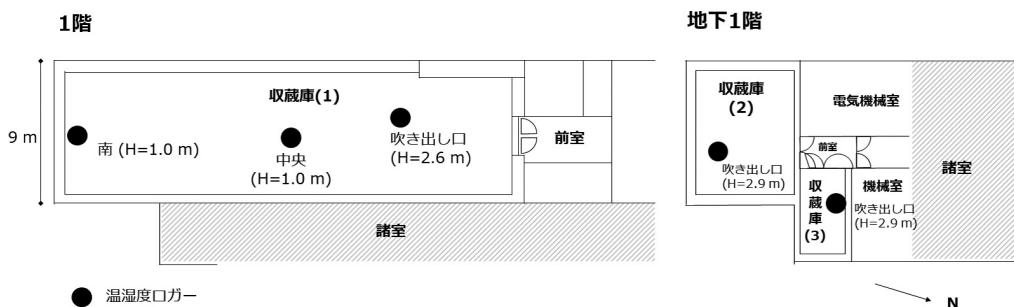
収蔵庫周辺の平面図と温湿度ロガーの設置位置
